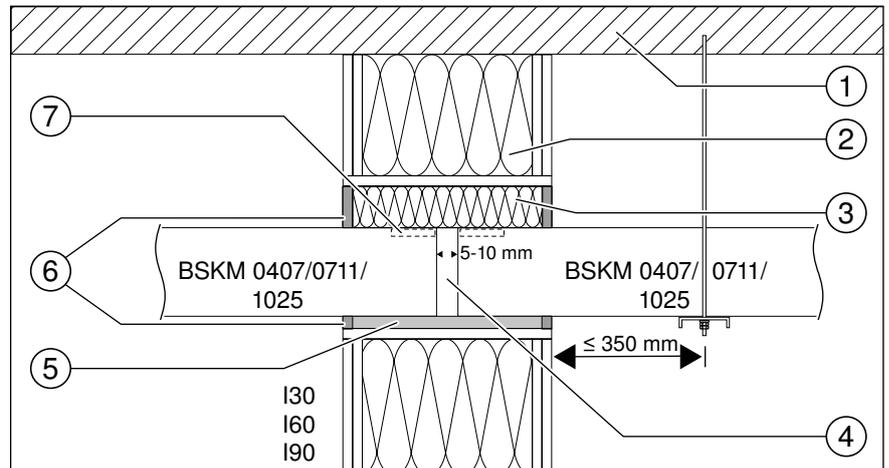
Wanddurchgang durch Trocken-/Leichtbauwand
